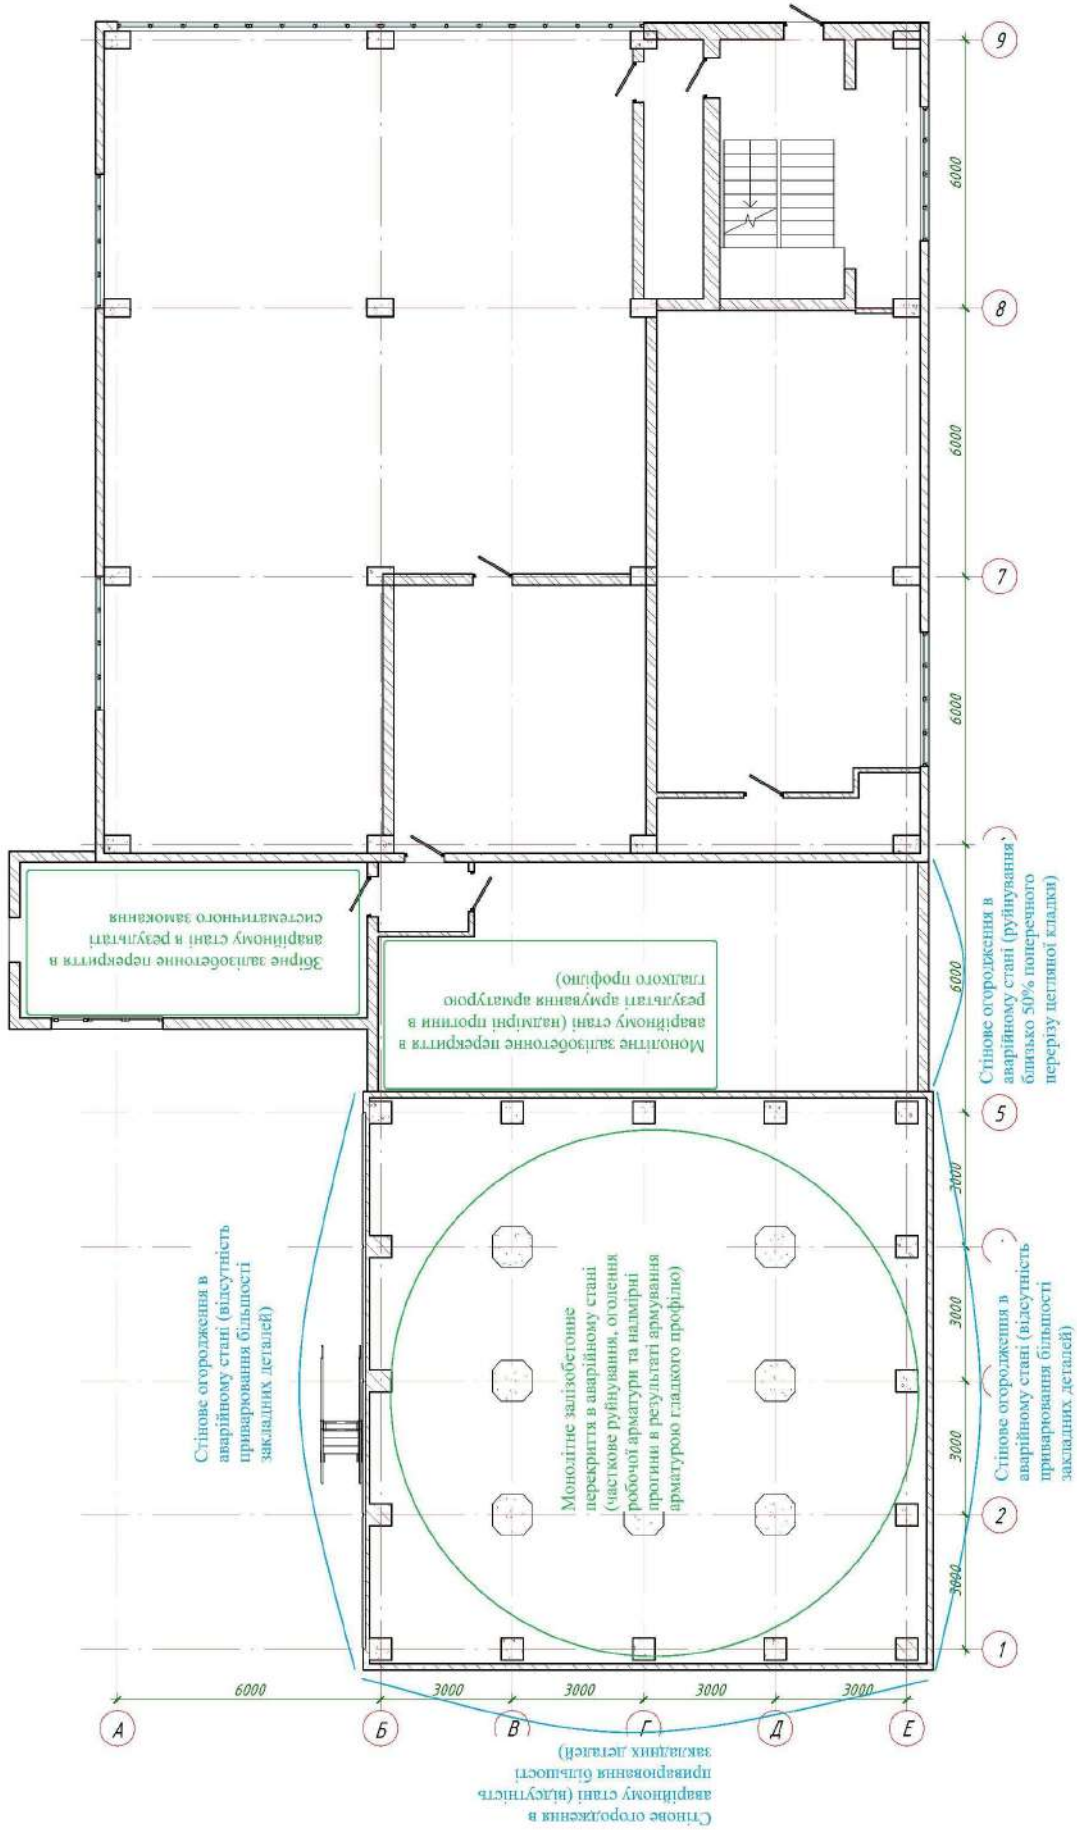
Схема виявлених дефектів, що впливають на подальшу надійну та безпечну експлуатації будівлі
